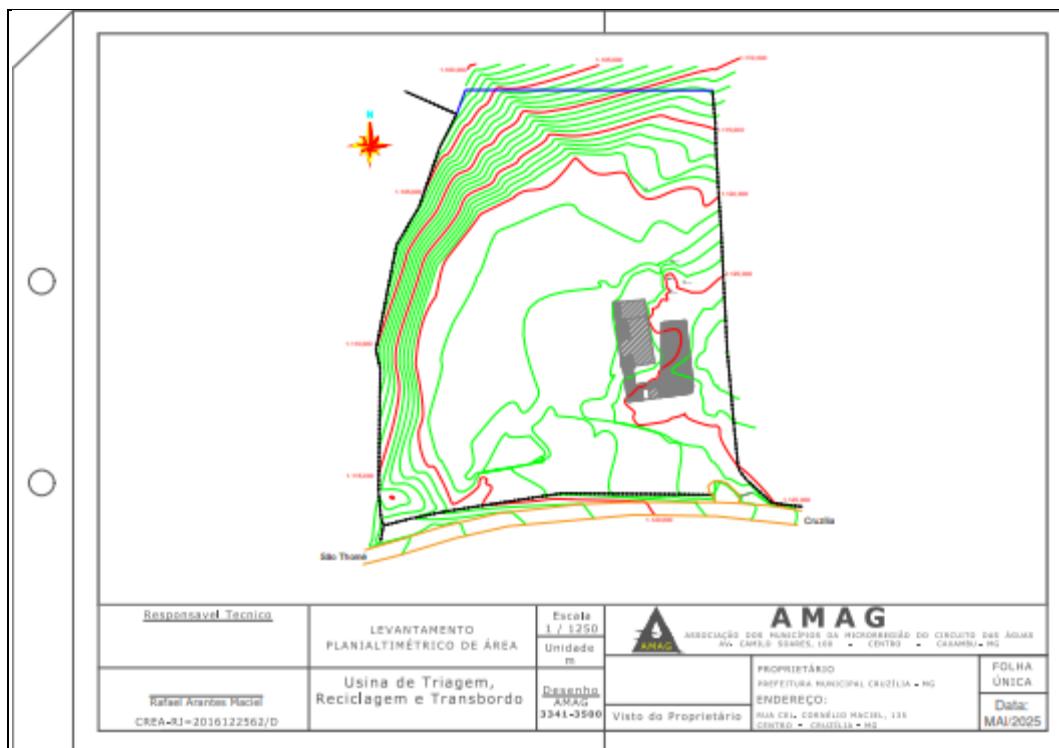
Planta de uso e ocupação do empreendimento. Fonte: SLA
